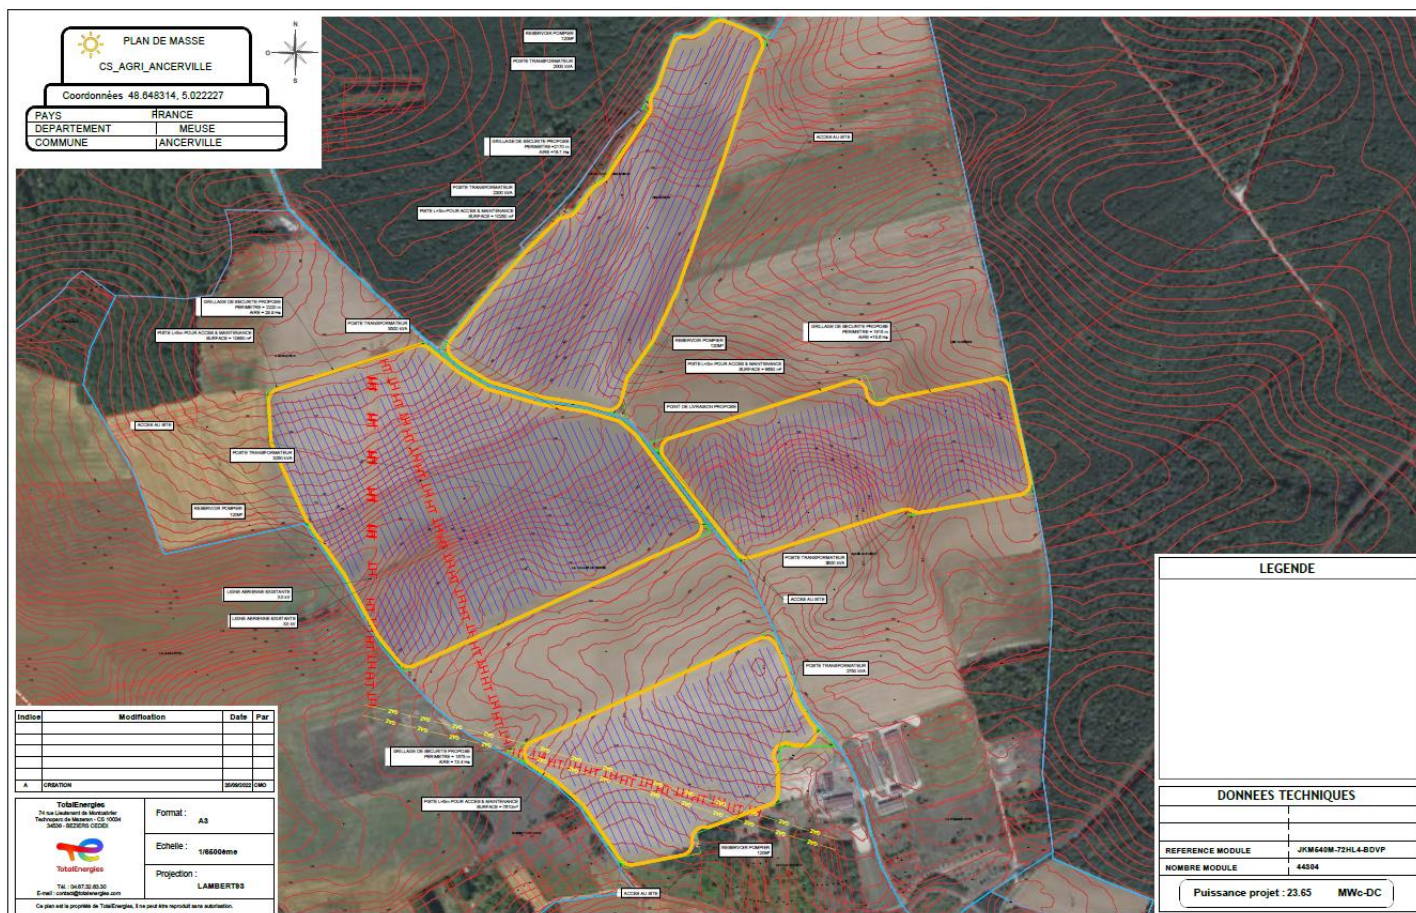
Plan de masse de la zone concernée par les panneaux verticaux
